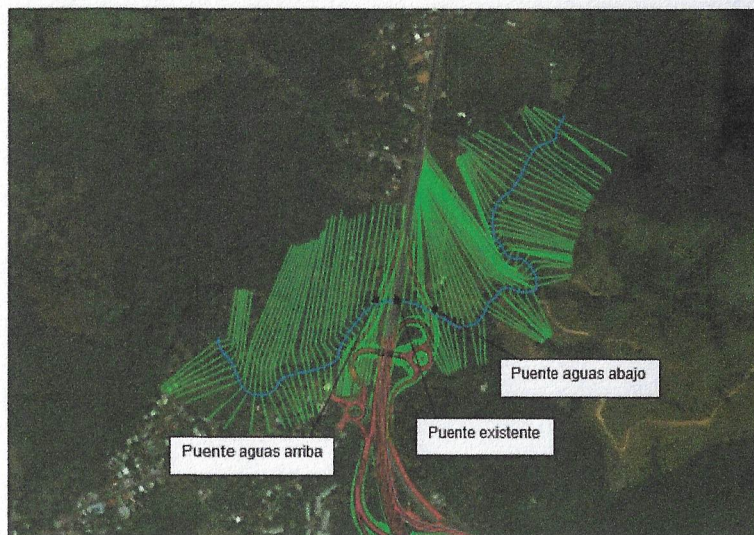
Corredor Las Playas, Tramo 1. Variante de Campana
